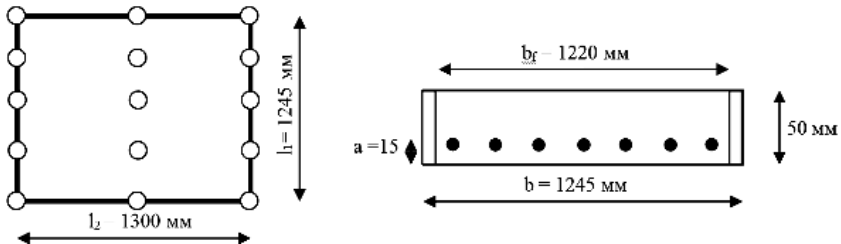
Расчетная схема и расчетное сечение ослабленной полки с креплением насквозь
